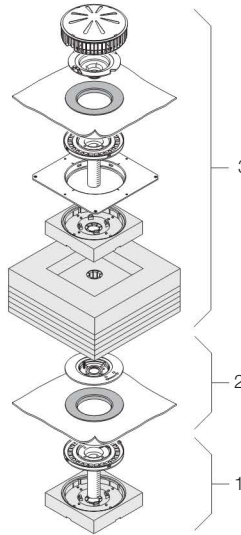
Komponenten Geberit Pluvia Dachwassereinlauf
